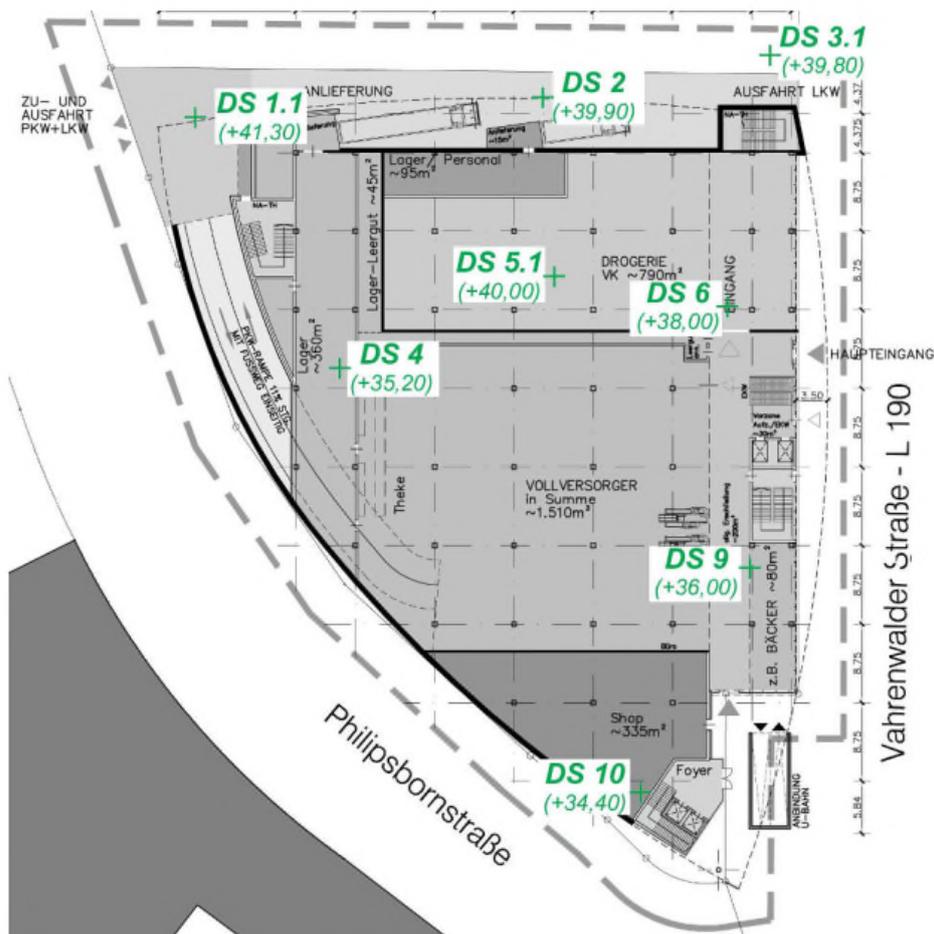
Lageplan mit Höhenlage des erkundeten Tonhorizontes in mNN.
